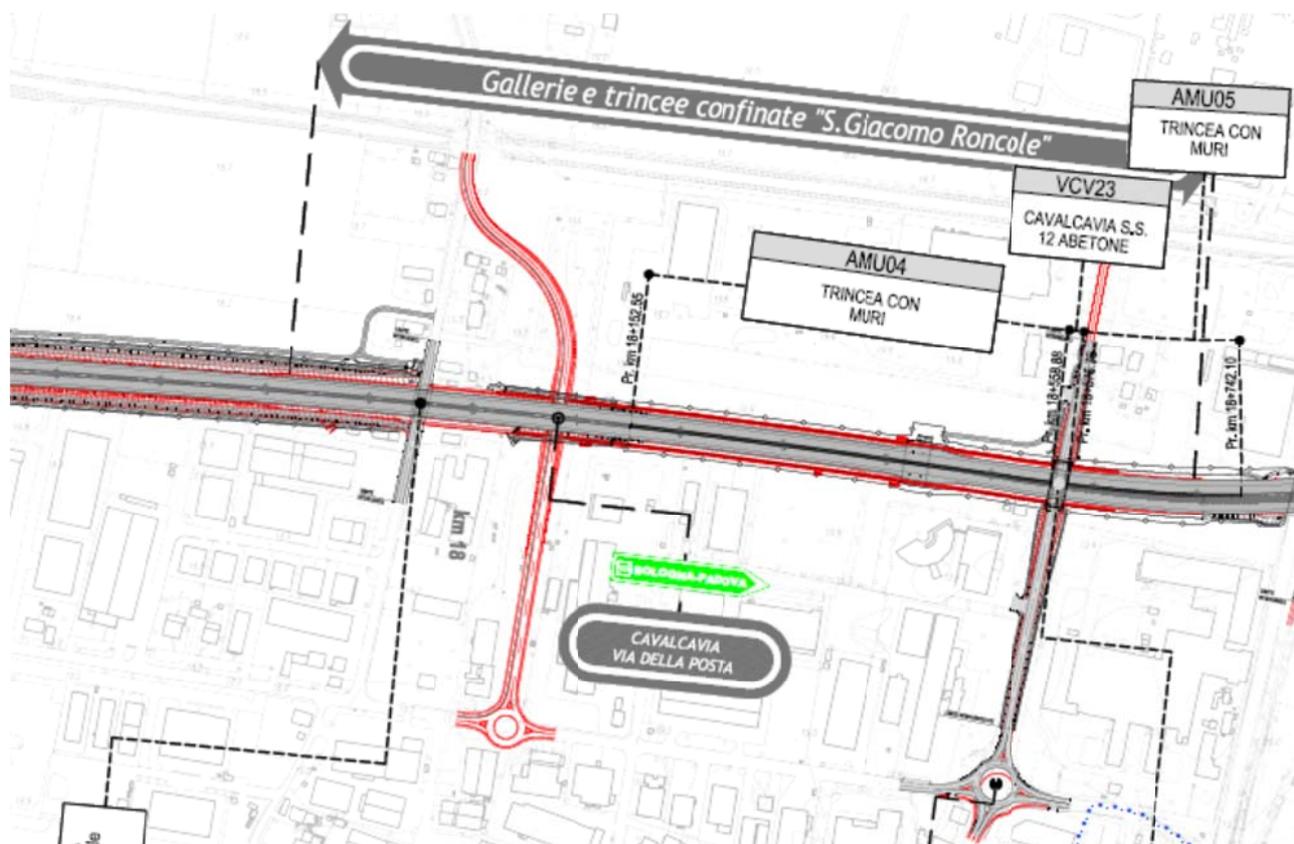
PLANIMETRIA TRINCEA E CAVALCAVIA SS12
